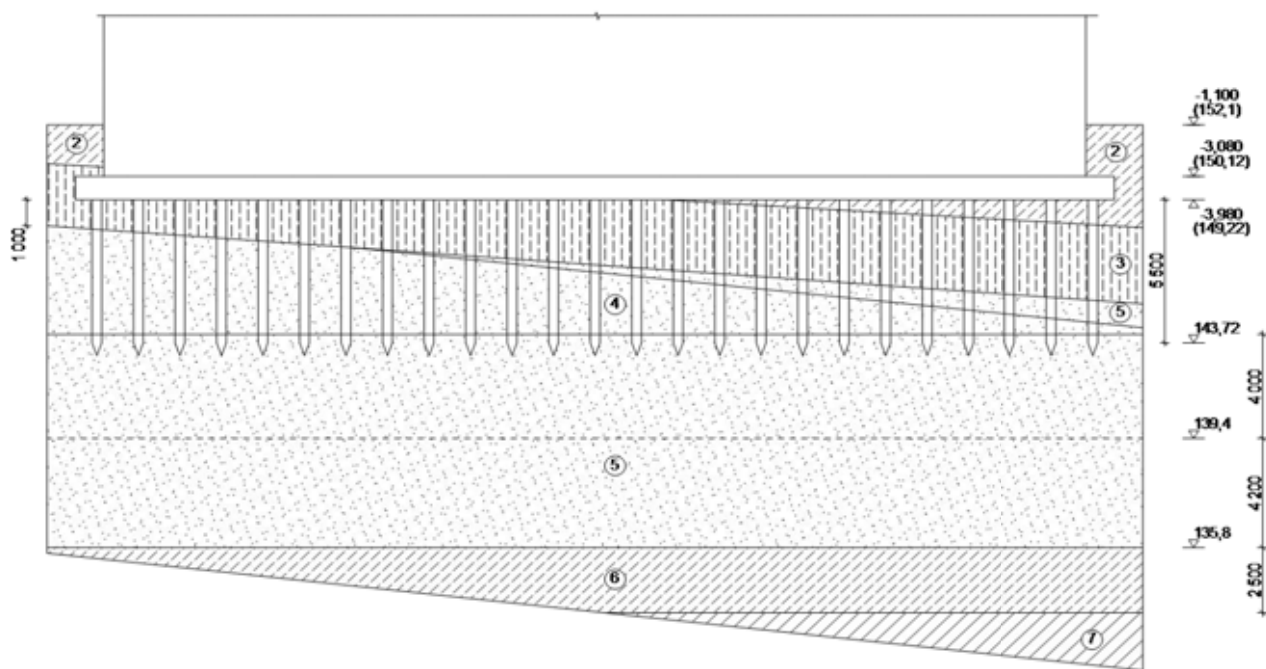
Геологічний розріз і положення фундаменту у ґрунті
